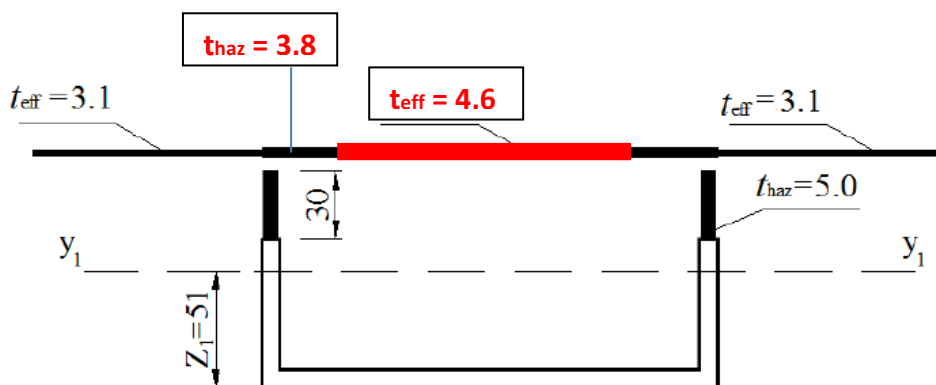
Sezione efficace per effetto dell'instabilità locale e delle HAZ.
